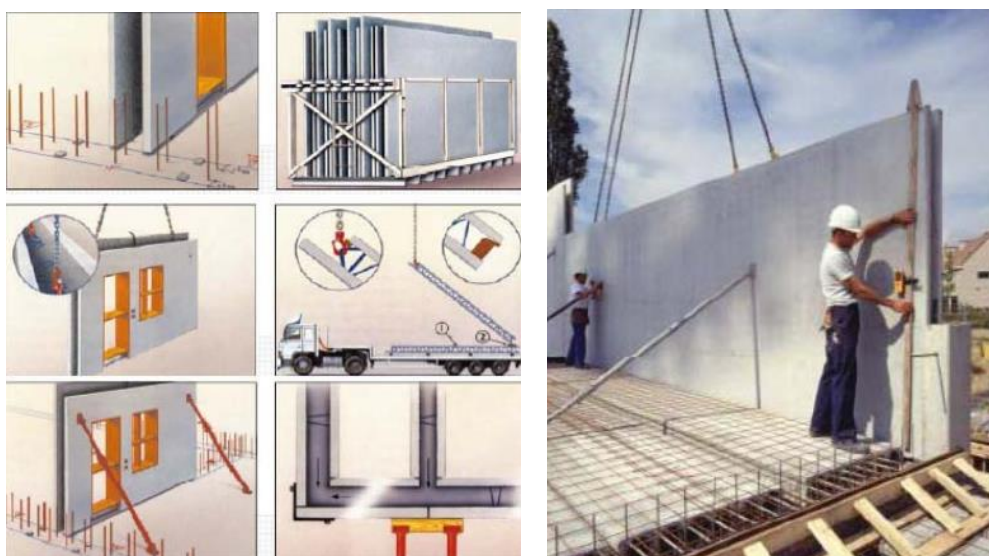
Proceso de montaje de los muros de Hormigón Prefabricado.
